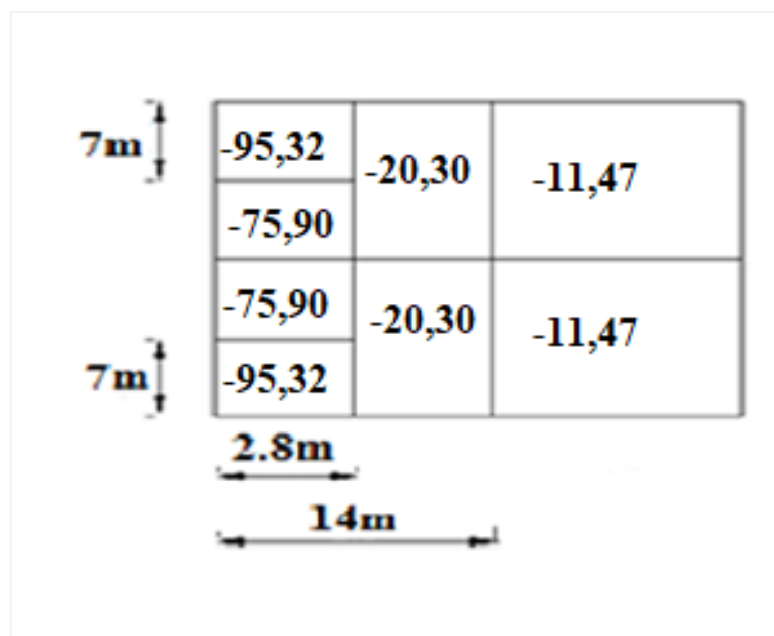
Pression du vent N°1 sur la toiture (Pignon)
